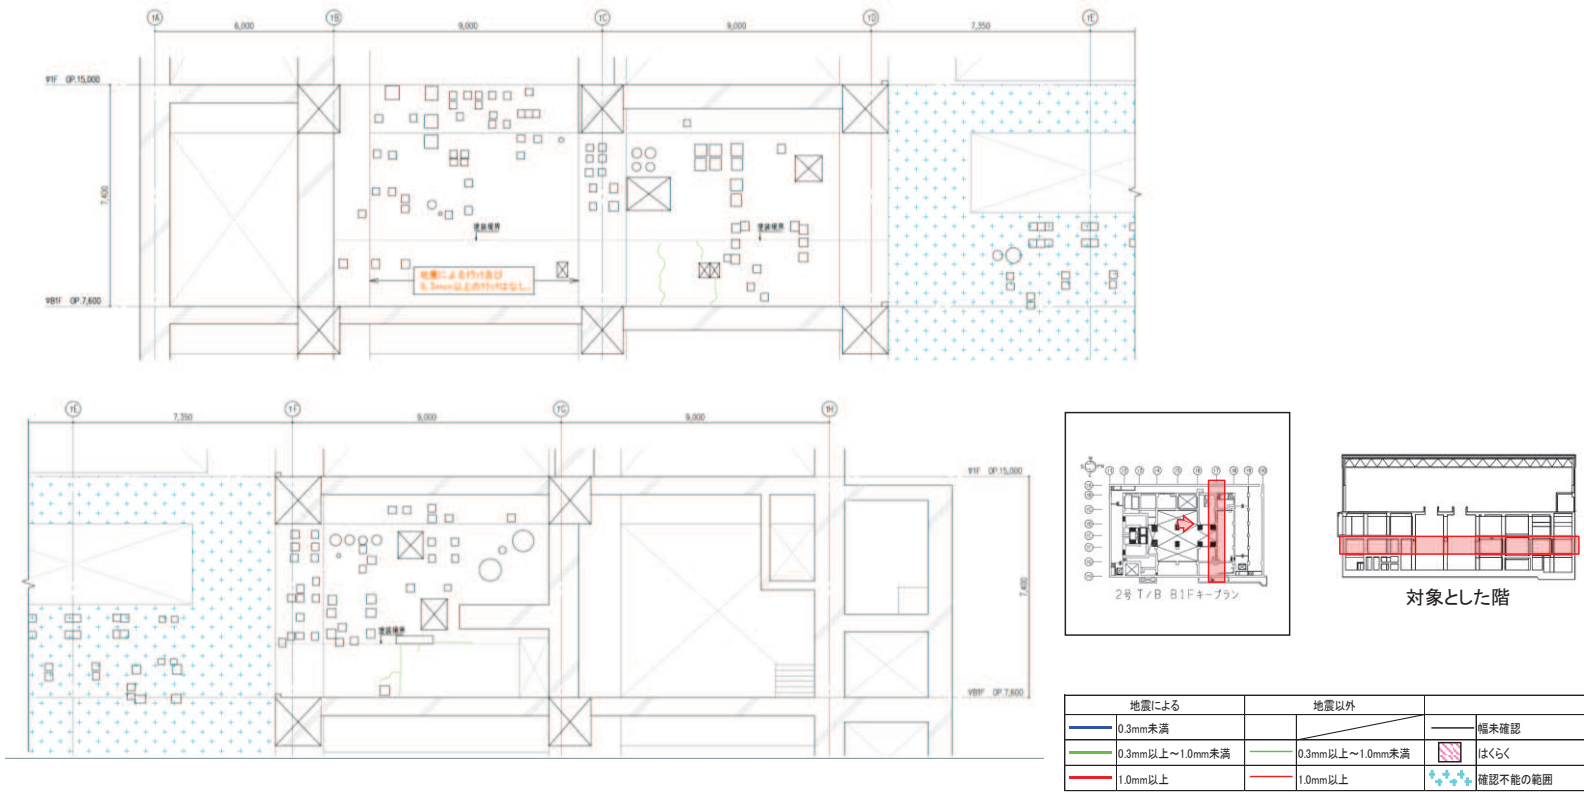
タービン建屋のひび割れ分布 耐震壁 (23) 地下 1 階 T7 通り
